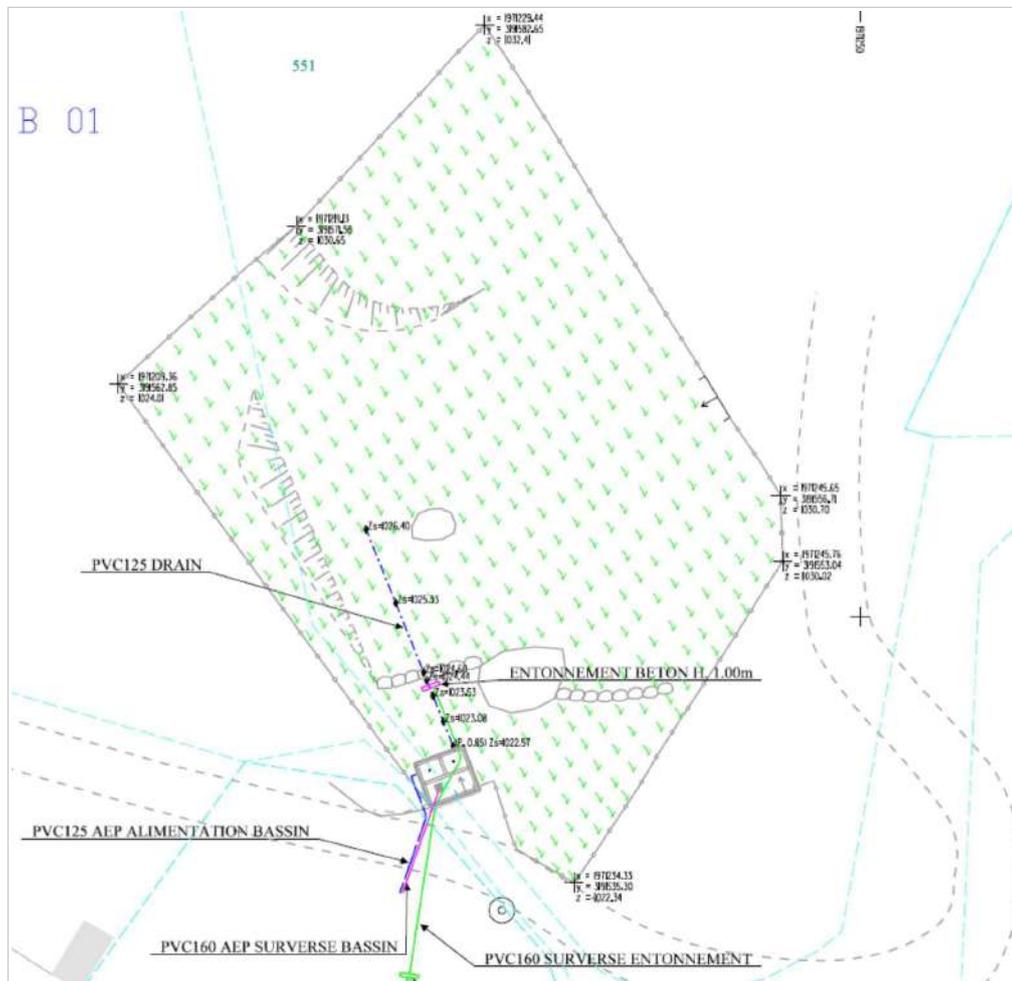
Extrait du plan de recollement parcellaire des Ferrayes (source : MAUREL TP)
